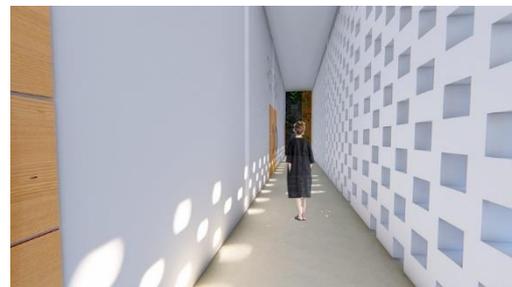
Akses *view healing garden* di sepanjang bangunan pelayanan
